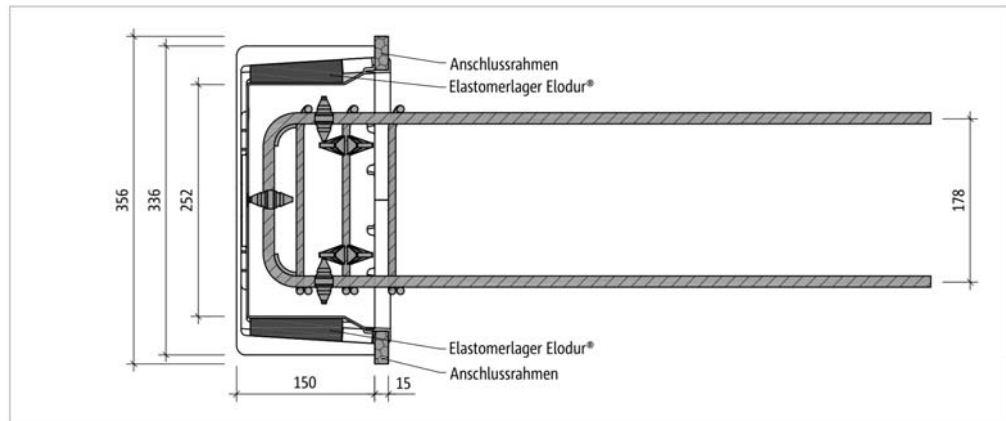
Schöck Tronsole® Typ Z-VH+VH-T: Horizontalschnitt
